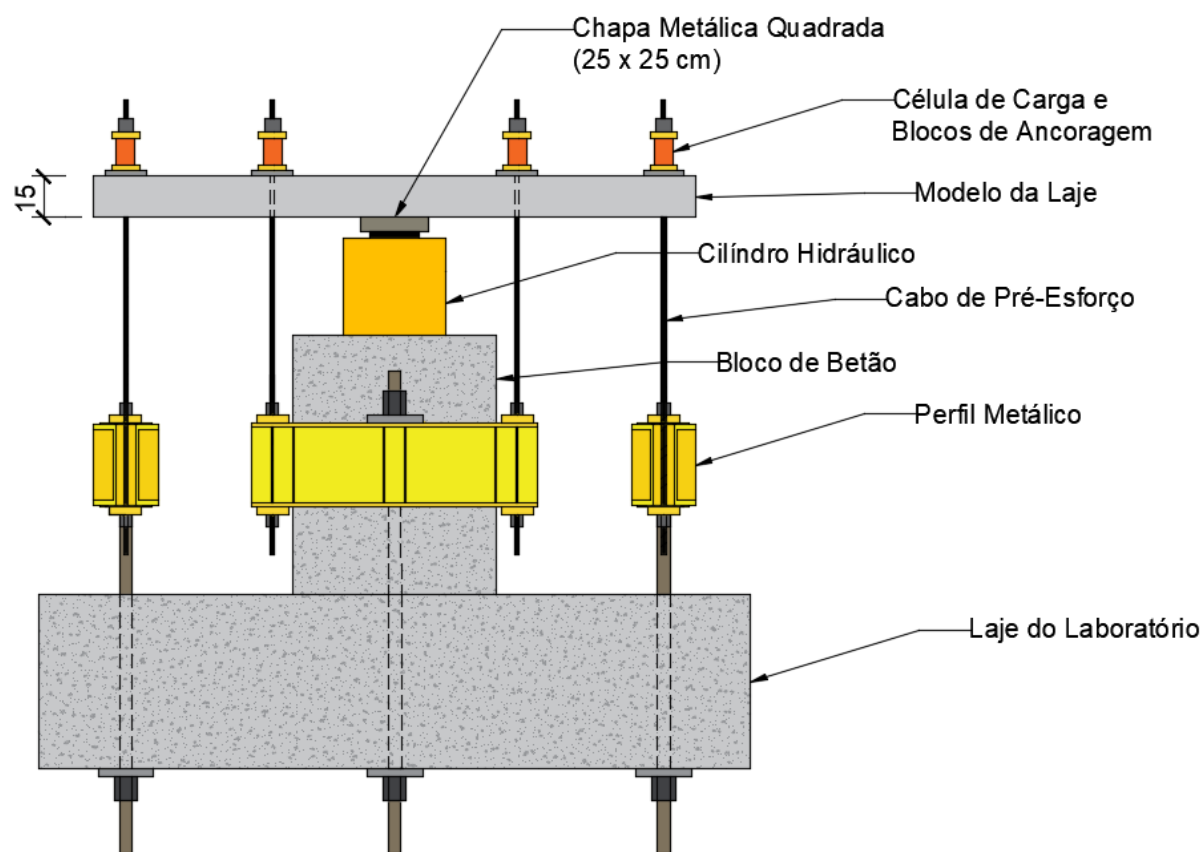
Sistema de Ensaio (dimensões em cm)
